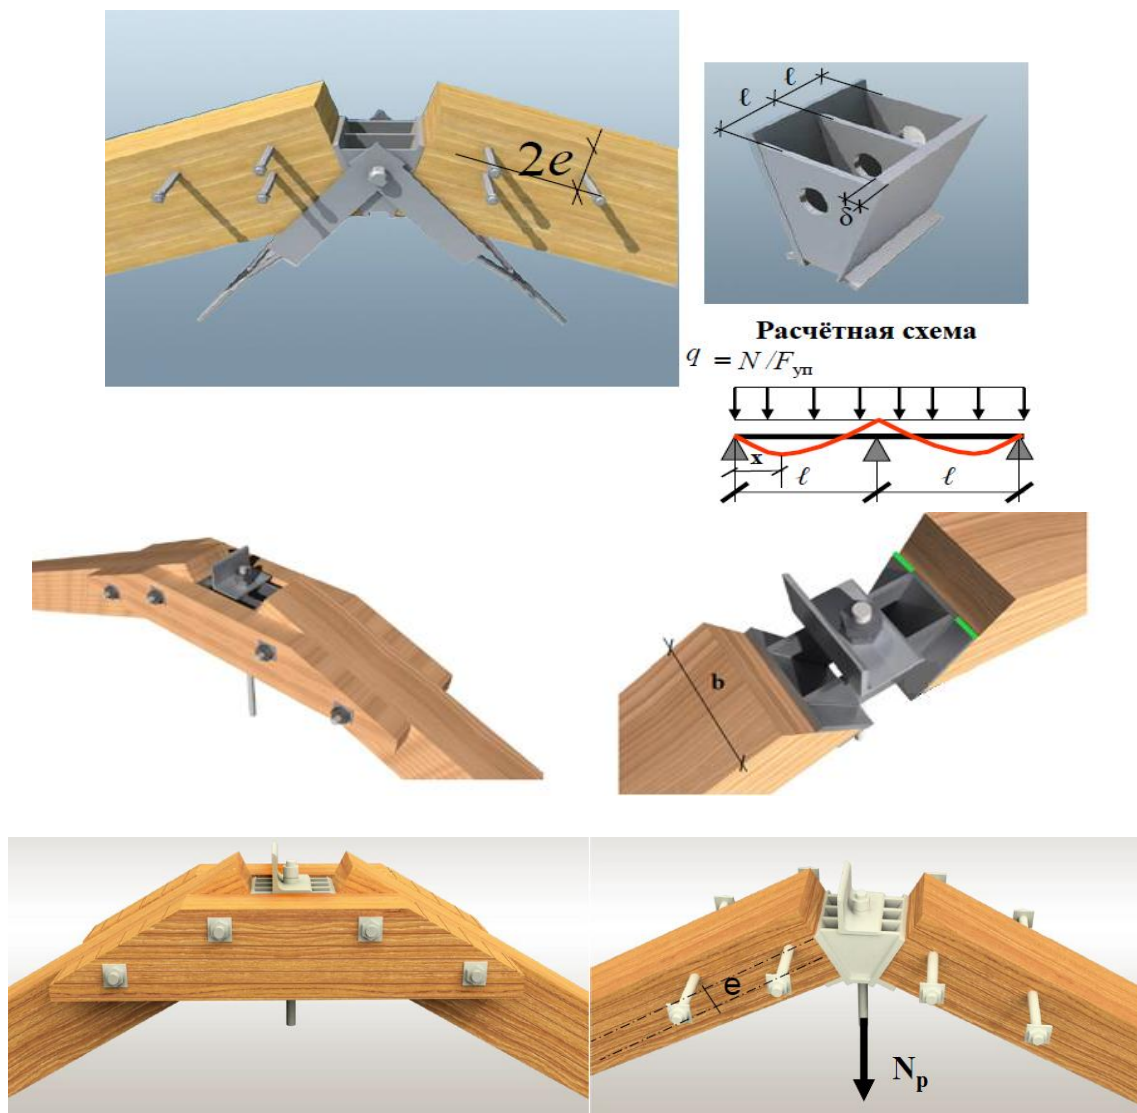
Коньковый узла фермы с узловым вкладышем
